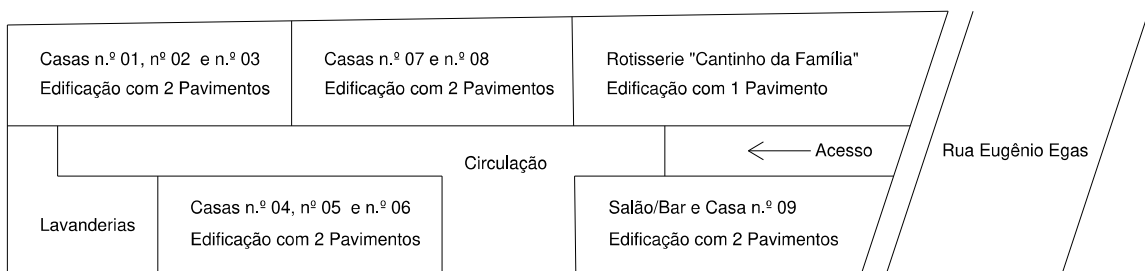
Planta esquemática da situação do imóvel na data da Vistoria
